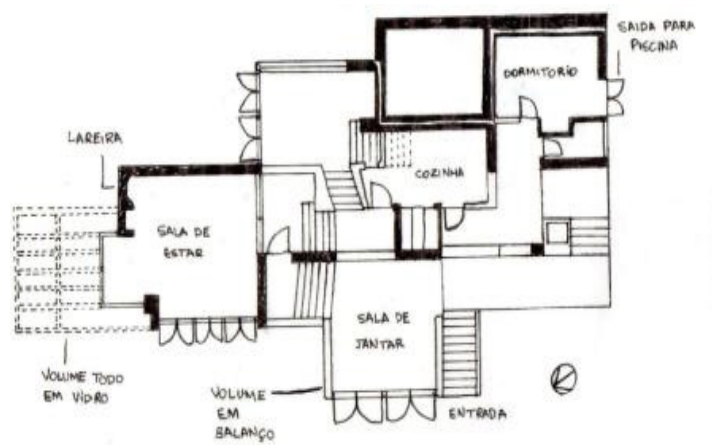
Planta do pavimento térreo, com os breves lances de escadas conectando os ambientes.
